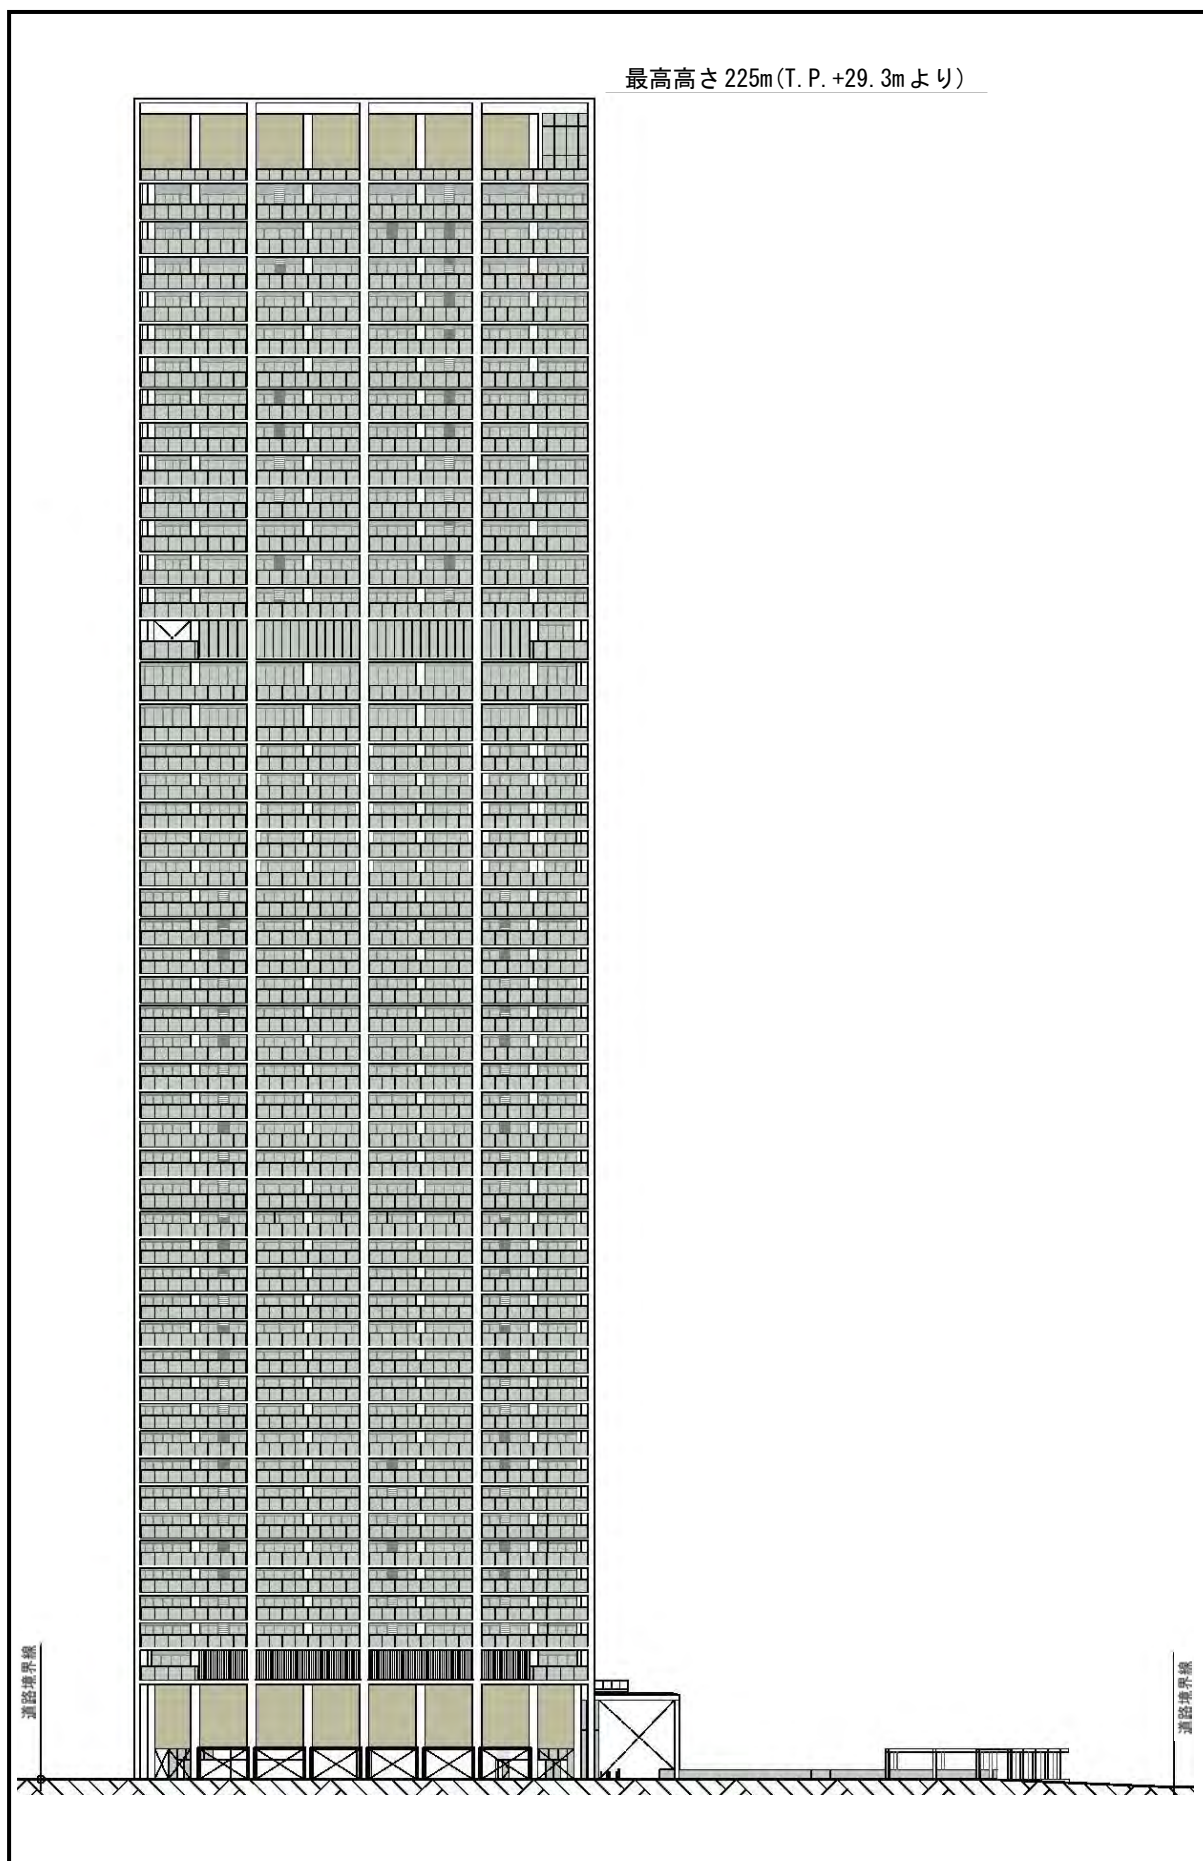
(4) 立面図 (西立面図 S=1:1,000)
